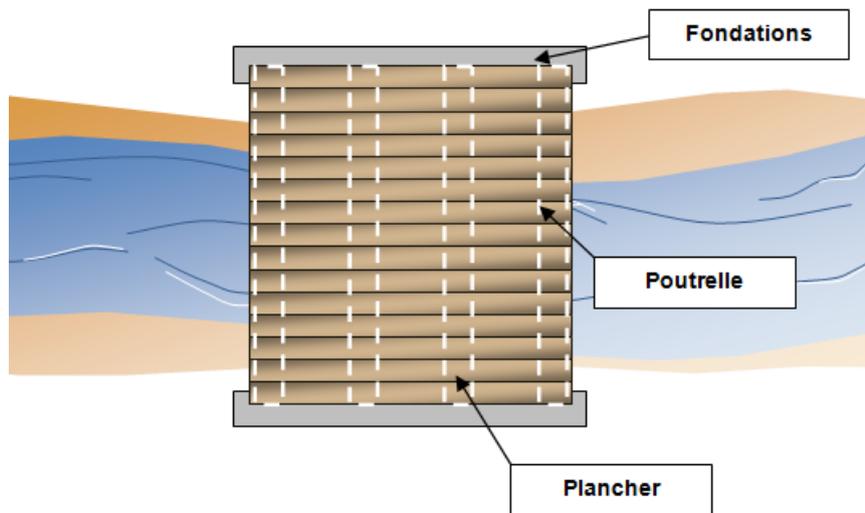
Schéma de principe d'une passerelle de franchissement
